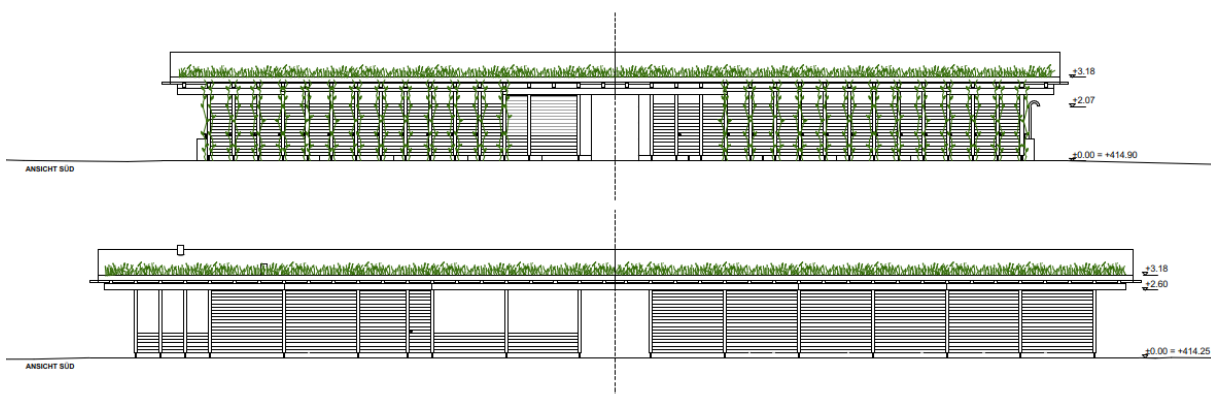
Ansichten Bad- und Sportpavillon (oben) und Gastropavillon (unten), Stand Bauprojekt
